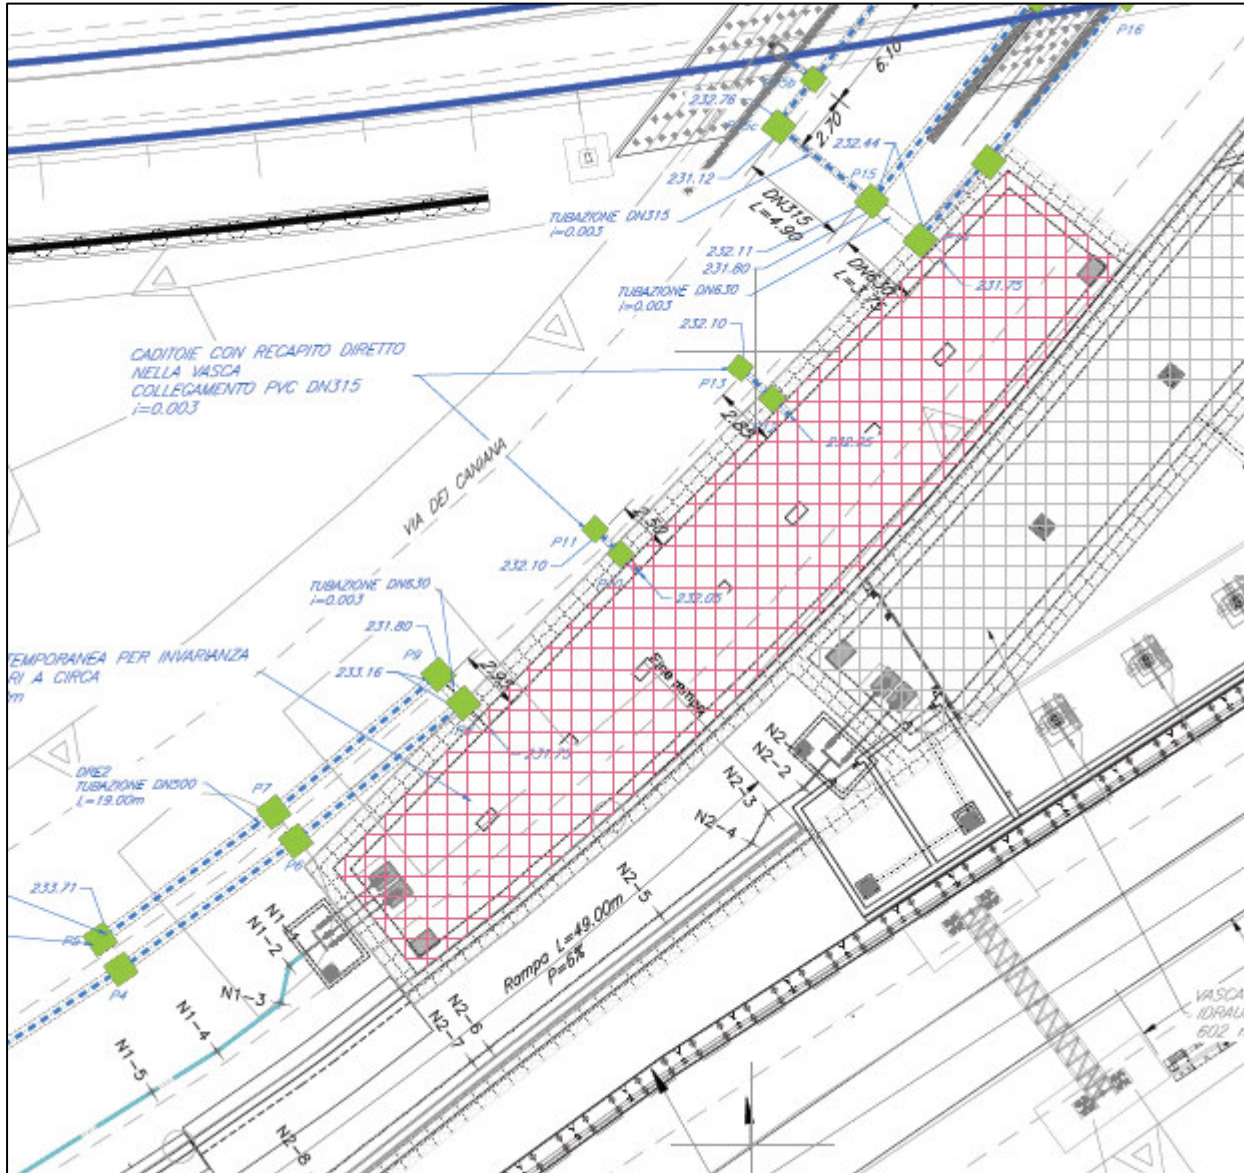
Stralcio planimetria vasca di via Caniana.
